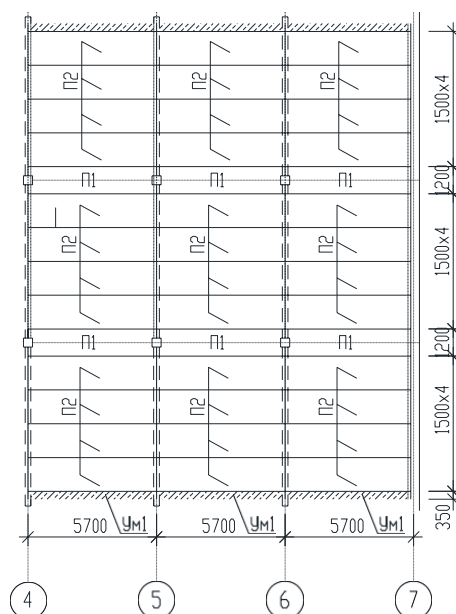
Схема компоновки участка (в осях 4-7)сборного перекрытия
